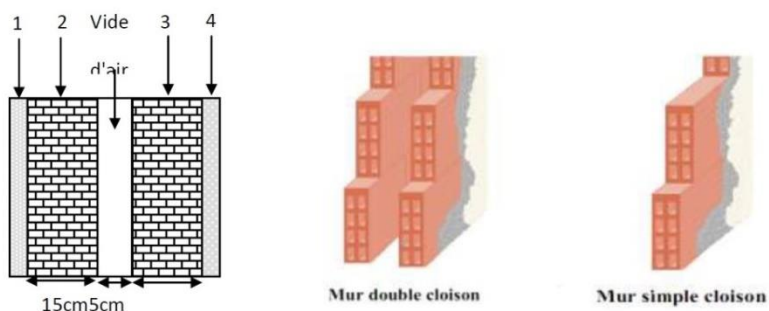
Coupe verticale d'un mur extérieur.❖ Dalle pleine (Balcon) :
